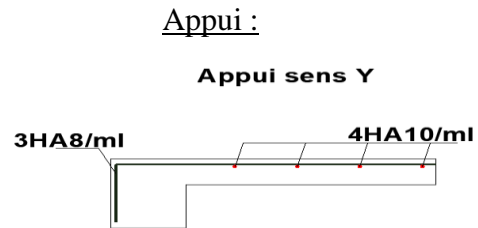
Ferrailage en appui de la DP4 sens Y
